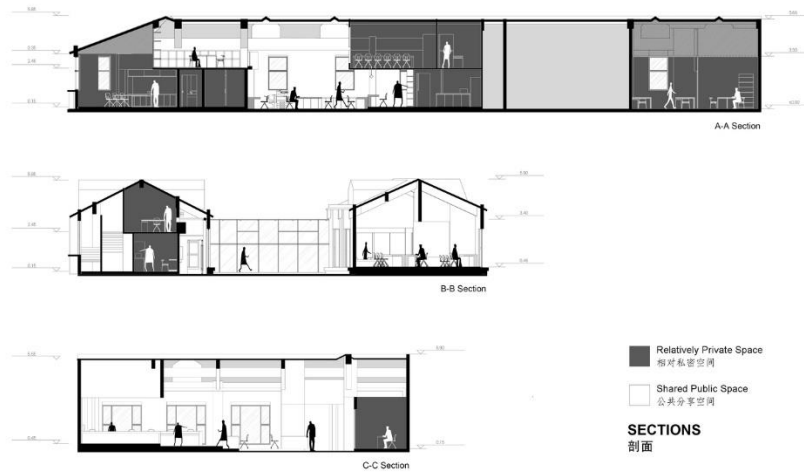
Denah Zhongshan Road CoWorking Space
